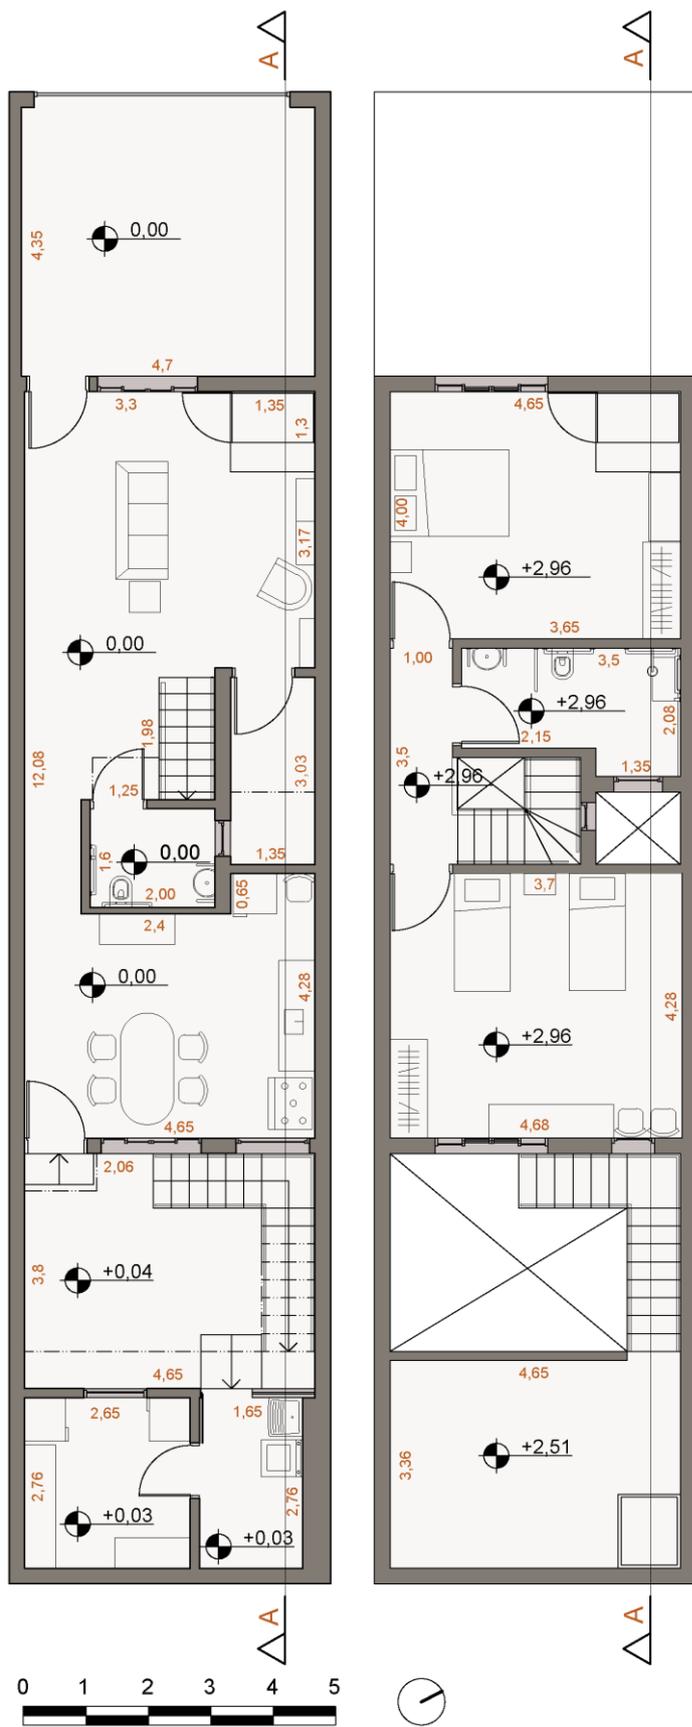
Plantas dos pavimentos inferior e superior da proposta 2.
